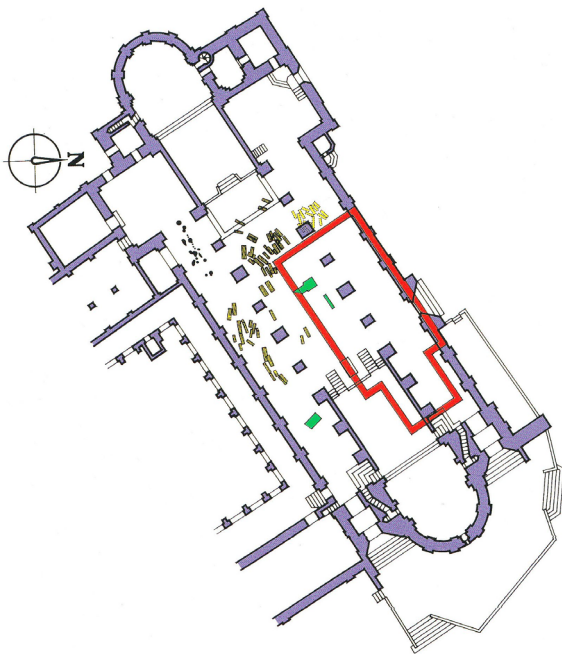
Rekonstruierter Grundriss der Burgkapelle mit Burgfriedhof. Ch. Dümmler.
